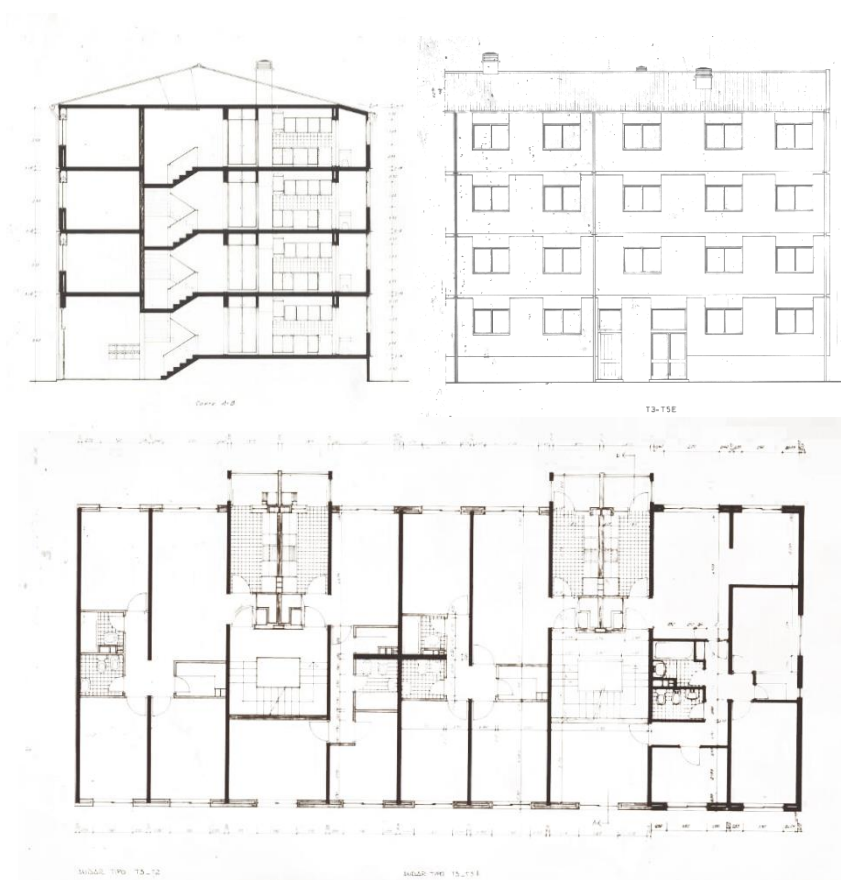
Planta geral de implantação esc. 1:500, Planta andar tipo, Corte e Alçados esc. 1:50 e 1:80. Vértice - Centro de Projetos de Construção. Arquivo Municipal do Porto
